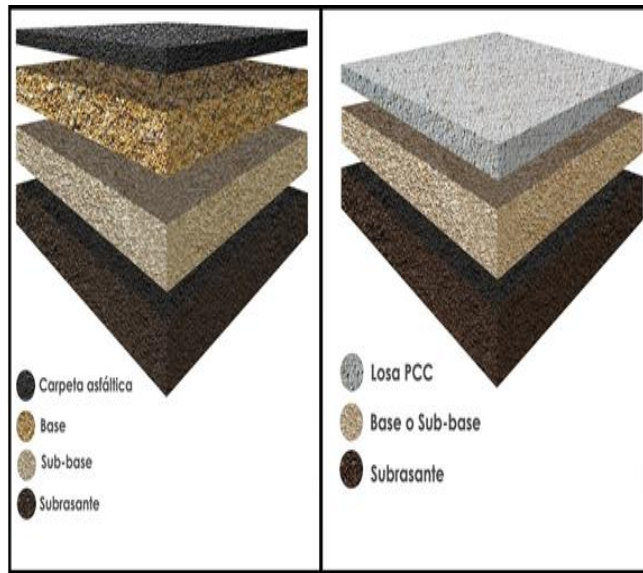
Imagen de la izquierda, corresponde a estructura de pavimento asfáltico, imagen de la derecha corresponde a estructura de pavimento de concreto hidráulico.
